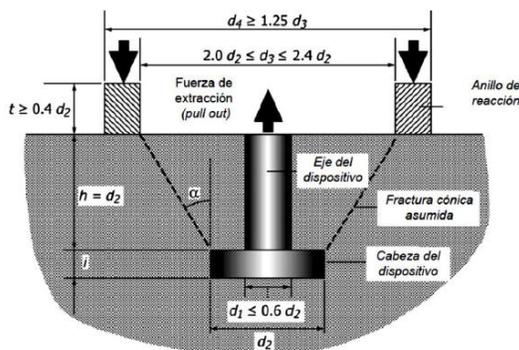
Sección esquemática transversal del ensayo de extracción por deslizamiento fundido en obra. Fuente: Norma NTG 41017 h26.
